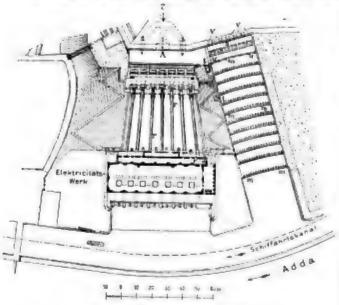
Detail-Lageplan des Elektricitätswerkes.
